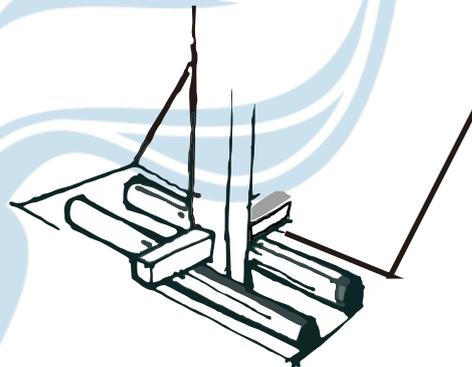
Pondasi Kalang Batang Untuk Struktur Beton.
